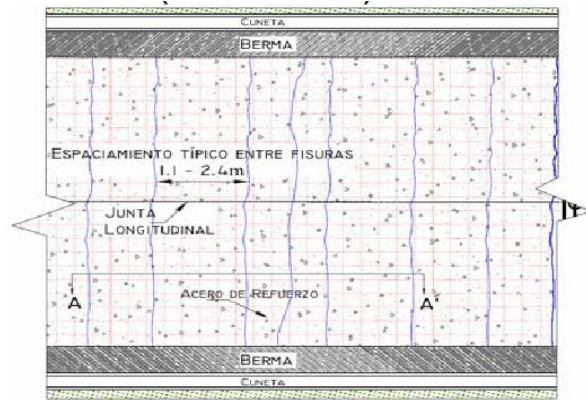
Concreto continuamente reforzado (Vista en planta)
